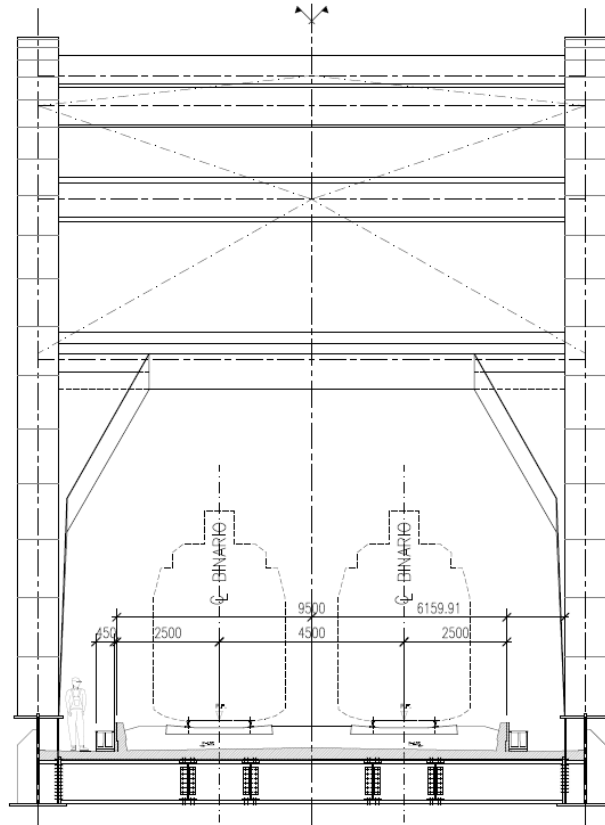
Sezione tipo - trasversale impalcato metallico da 78m.
